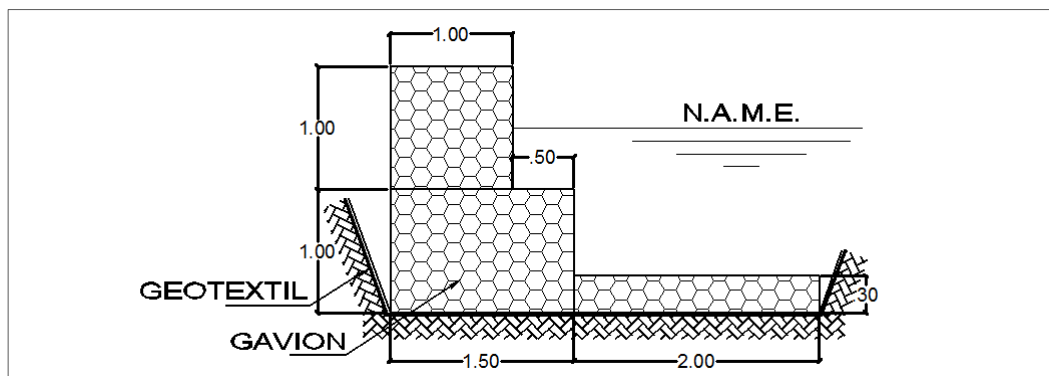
Sección propuesta de gavión, G-3G, h = 2.00 m y B = 1.50 m.
